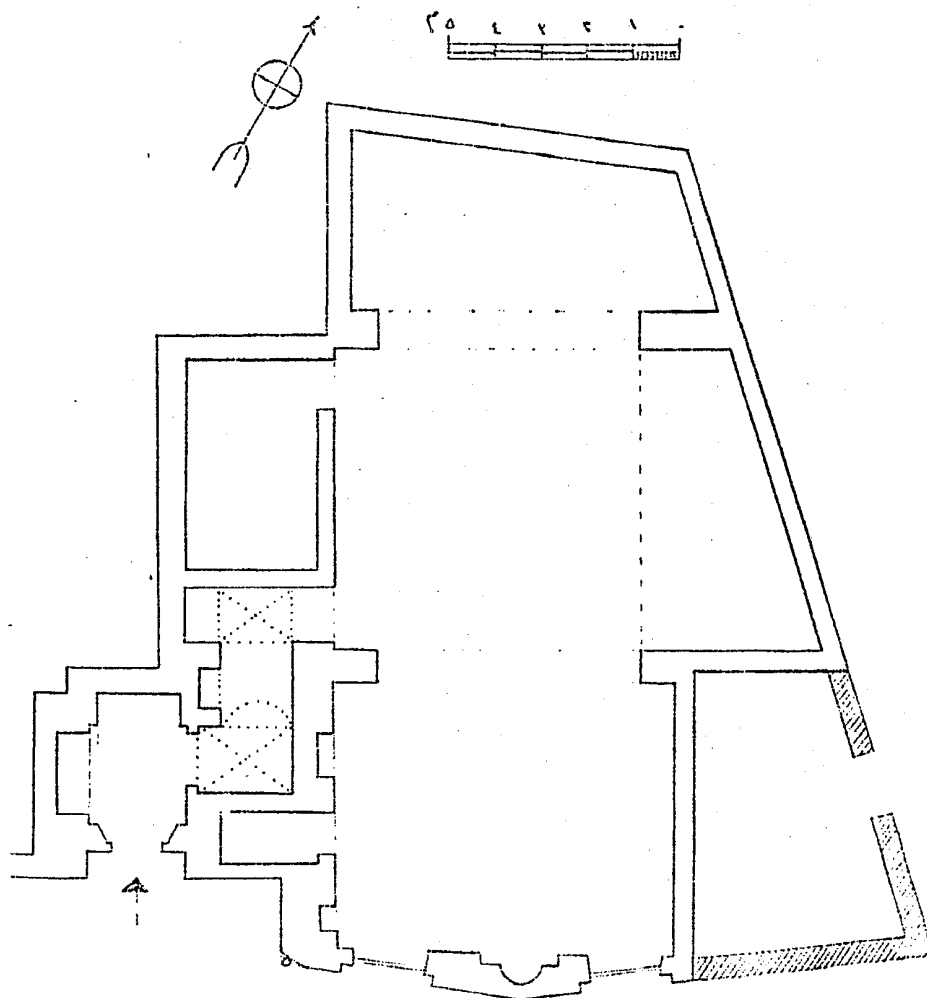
مسقط أفقي لجامع البرديني بالقاهرة .
